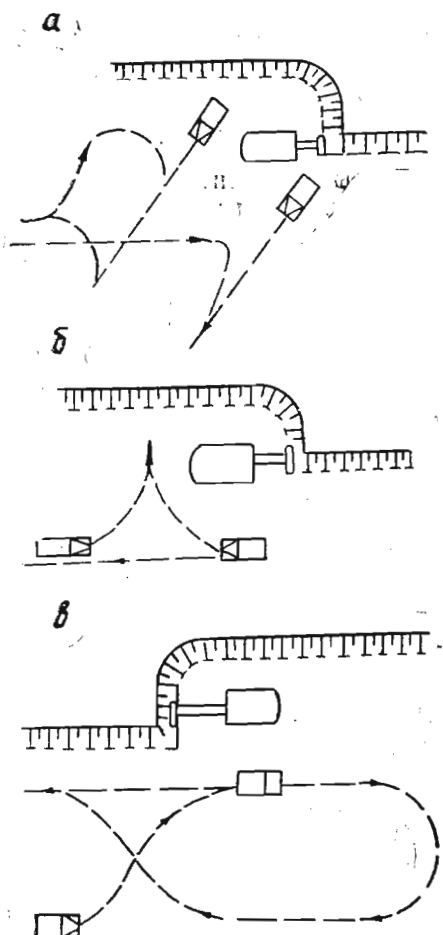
Схемы маневров и установки автомобилей у экскаватора под погрузку
